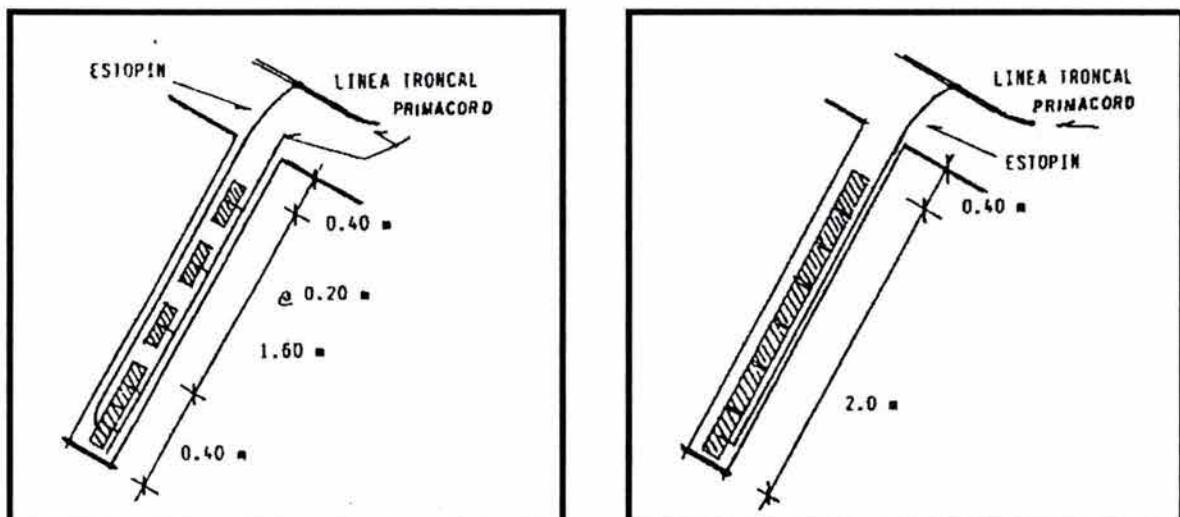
ANÁLISIS PARA LA BARRENACIÓN
